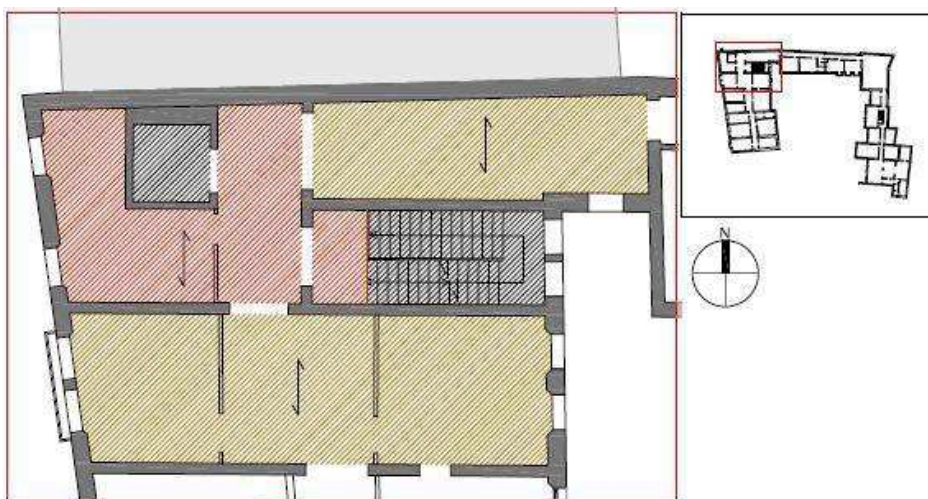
Secondo orizzontamento rilievo strutturale
